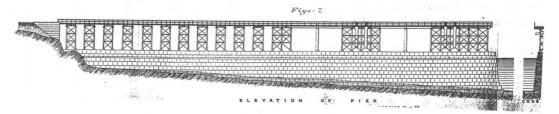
Plano de alzado del muelle (proyecto de Gillman 1908, archivo de los autores)
